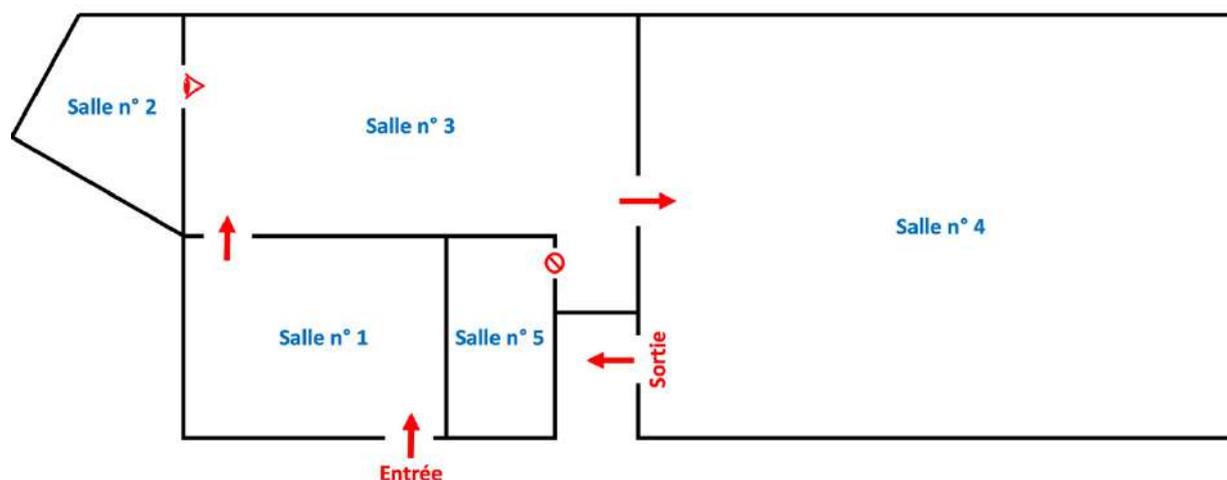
Plan des salles du MHEVL (Source : H.Jeannet)
